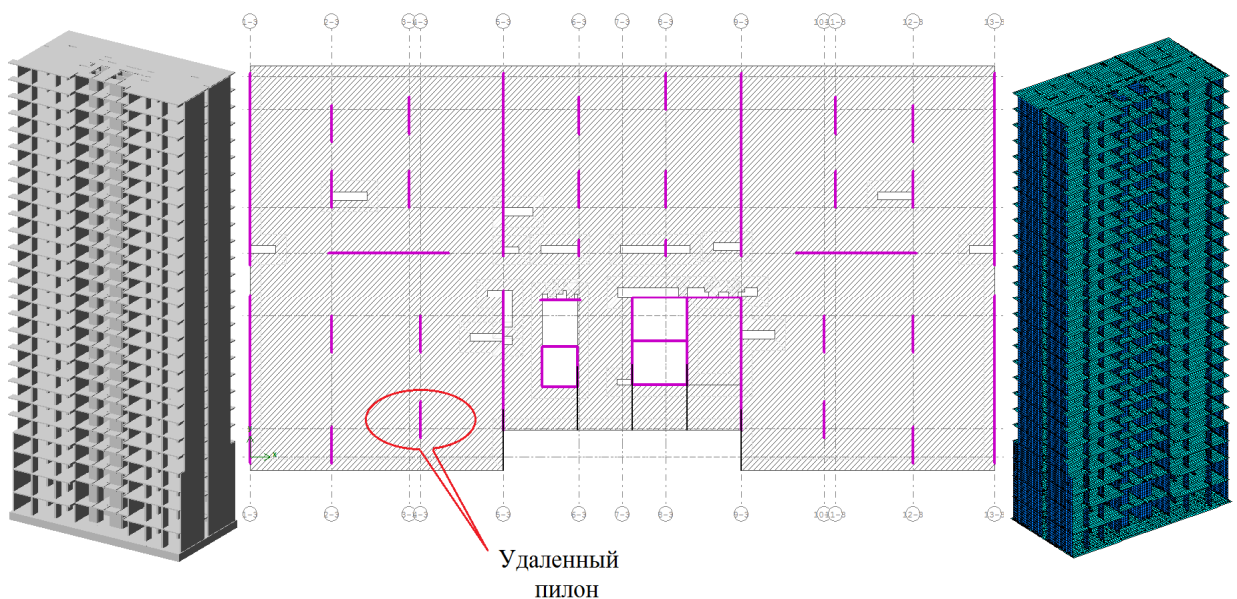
Просторова схема будівлі, плани поверхів і звичайно-елементна схема
